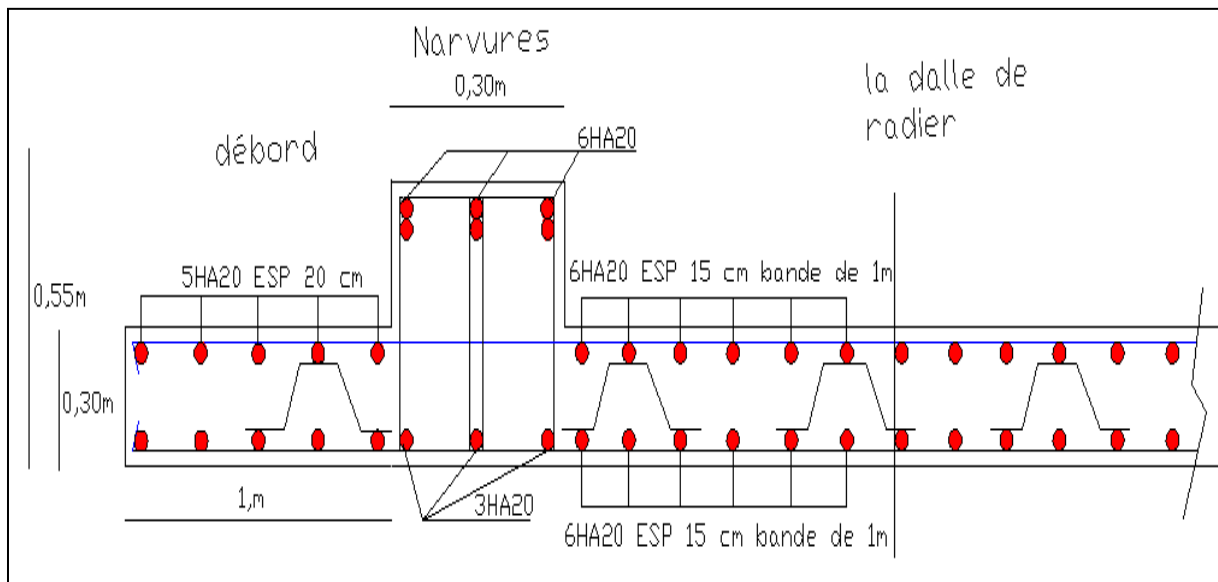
Ferrailage du radier générale sens X-X coupe en travée
